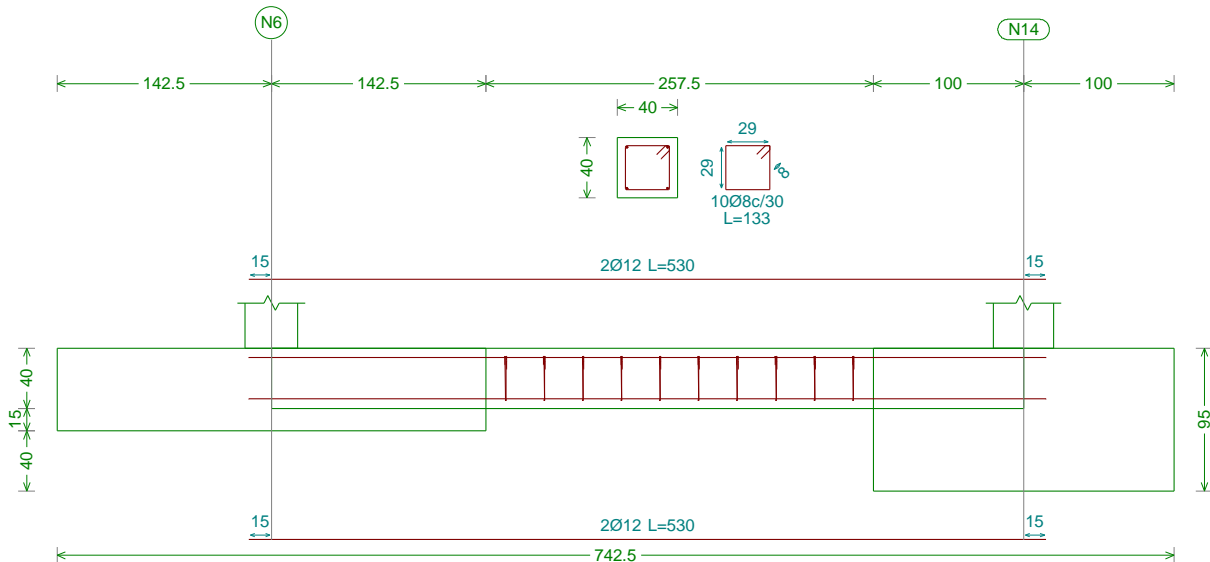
Detalle viga de atado tipo C.1 40x40.
